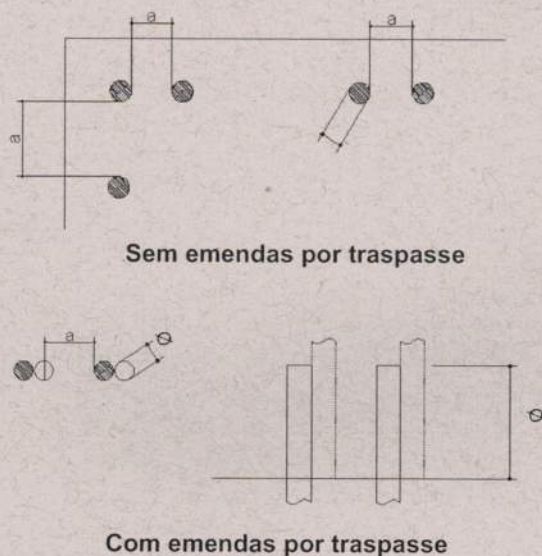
Espaçamento entre as barras da armadura longitudinal. (Pinheiro 2009)
